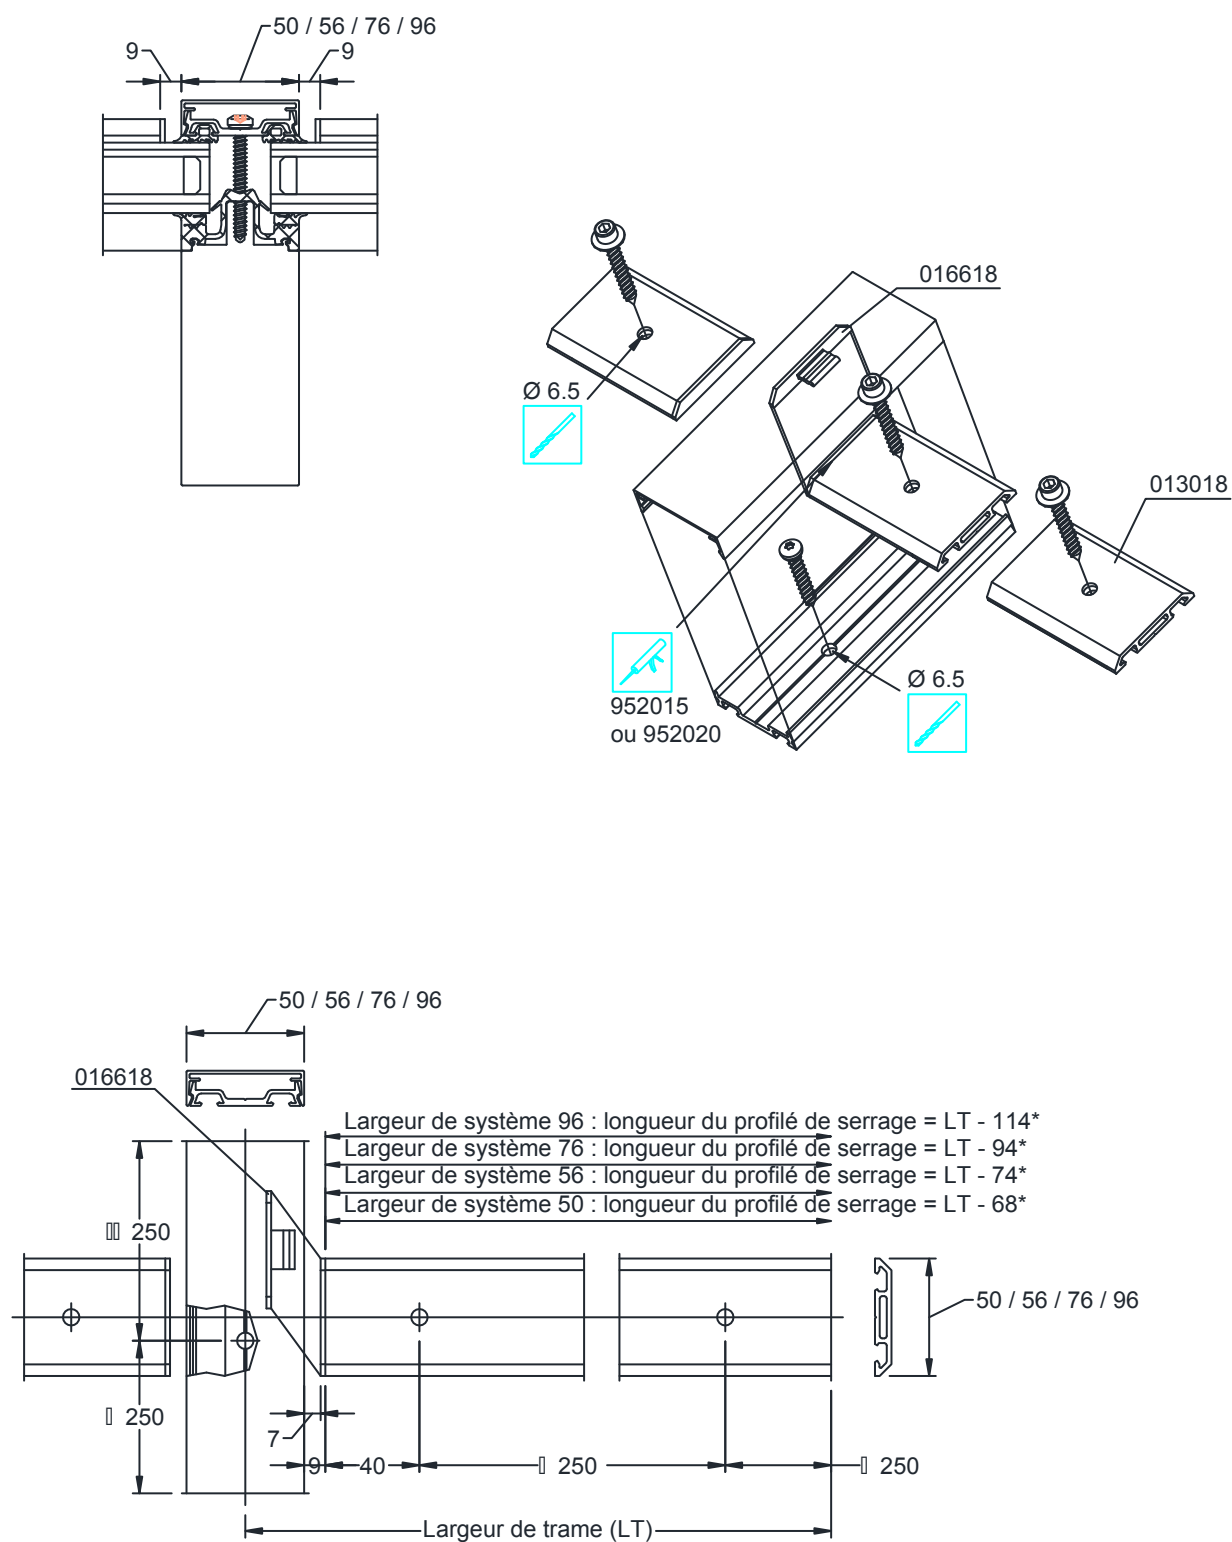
Découpe et usinage des profilés de serrage : serreur plat de 7 mm
